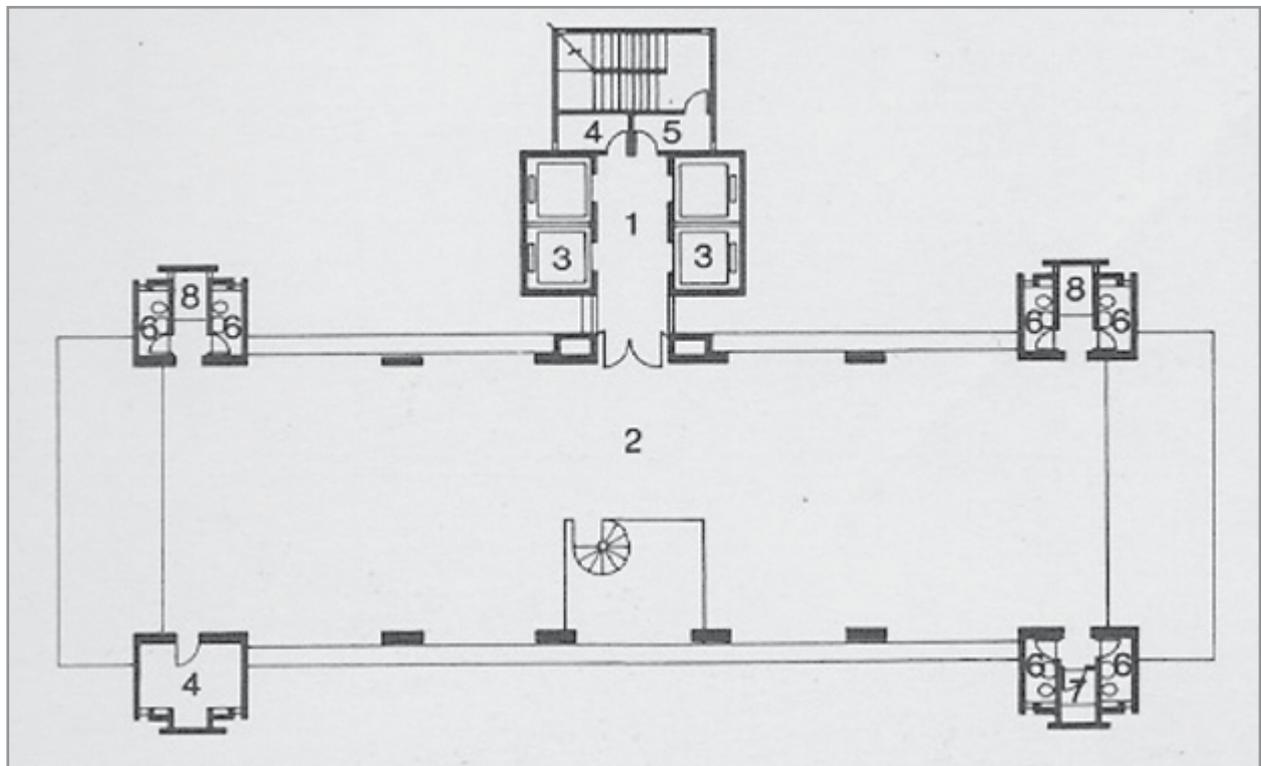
Planta do 2.º Pavimento - Fonte: Revista Projeto nº 110, Maio de 1988, página 91.
